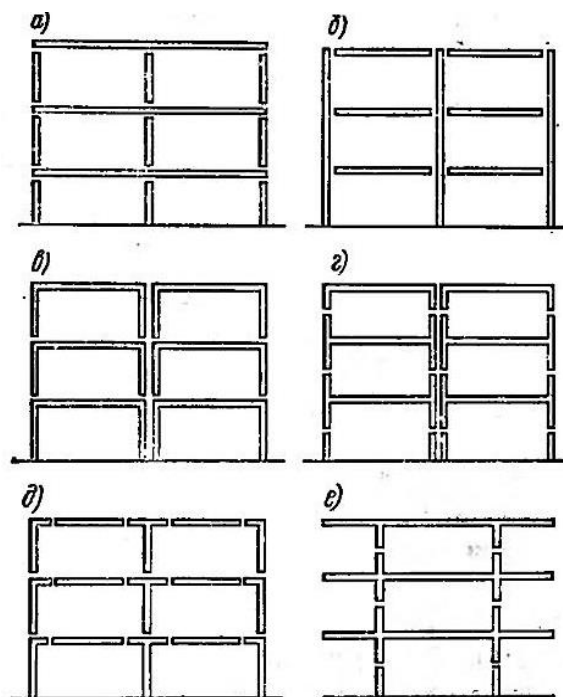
Схемы членения сборных железобетонных каркасов на составные элементы: а) одноэтажные колонны и двух пролетные ригели; б) многэтажные колонны и однопролетные ригели; в) П-образные рамы; г) Н-образные рамы; д) тавровые и Г-образные колонны и ригели-вставки; е) Н-образные рамы при консольной схеме [4]
